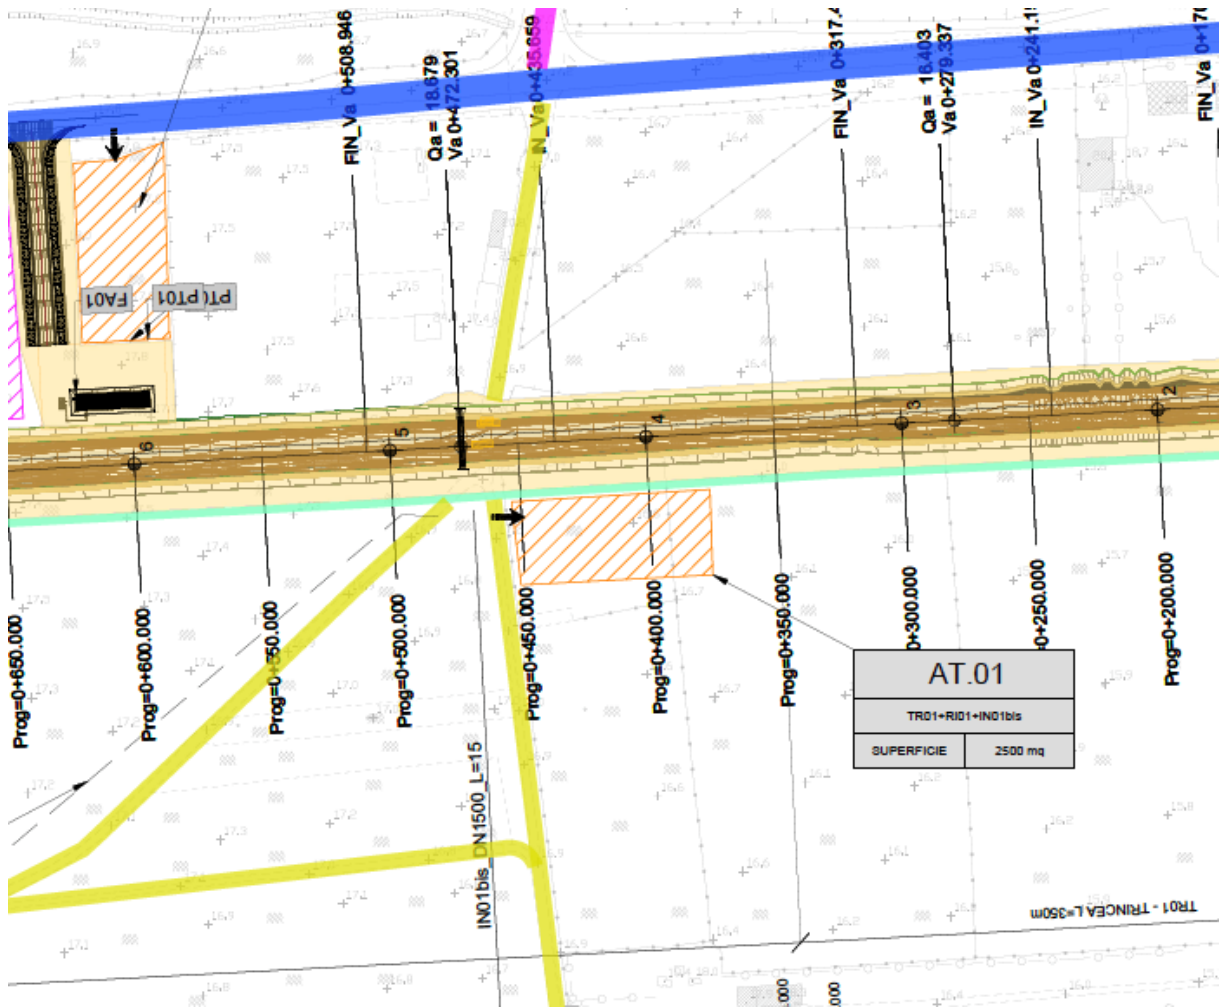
Vista in pianta dell'area di cantiere AT.01
